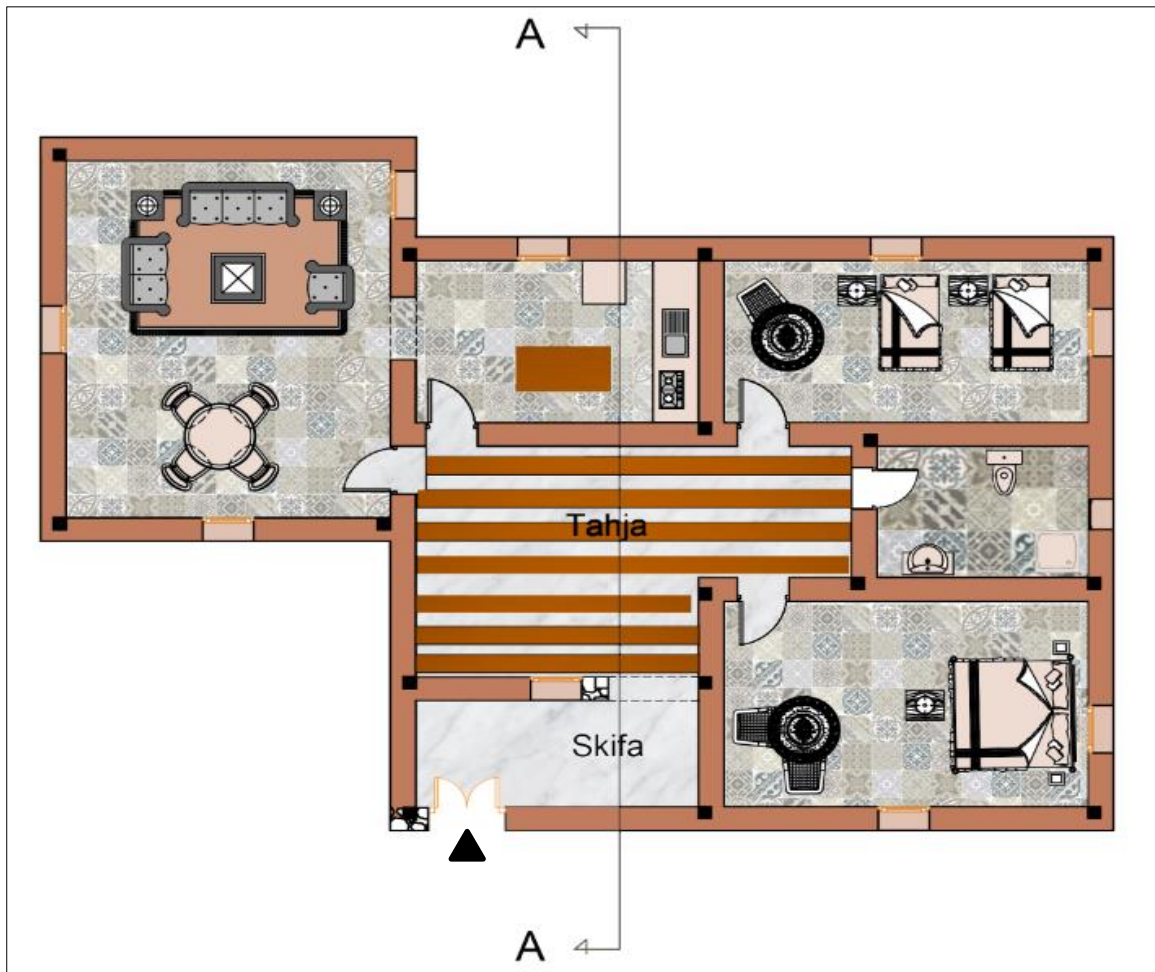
plan f3 échelle 1/100 (voir l'annexe 15)
